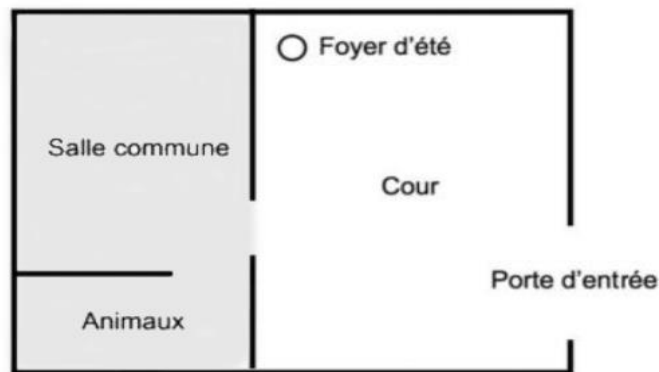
Plan schématique d'une habitation et de sa cour intérieure.
